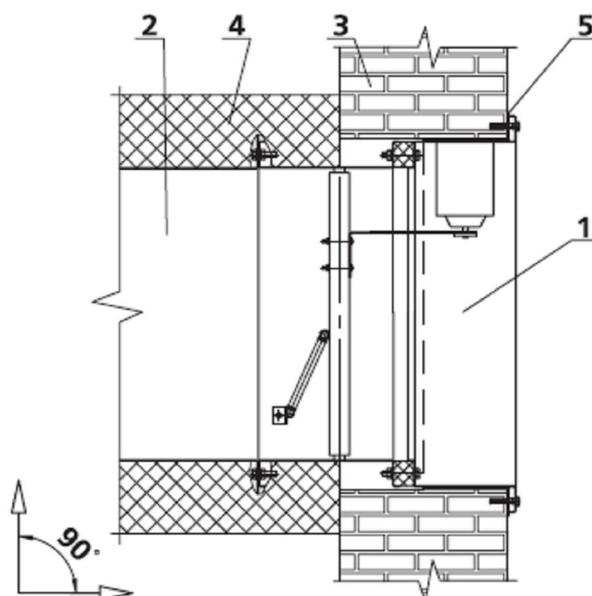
Монтаж стенового клапана в стене: 1 – клапан; 2 – воздуховод; 3 – стена; 4 – наружная теплозащита; 5 – монтажная рама
